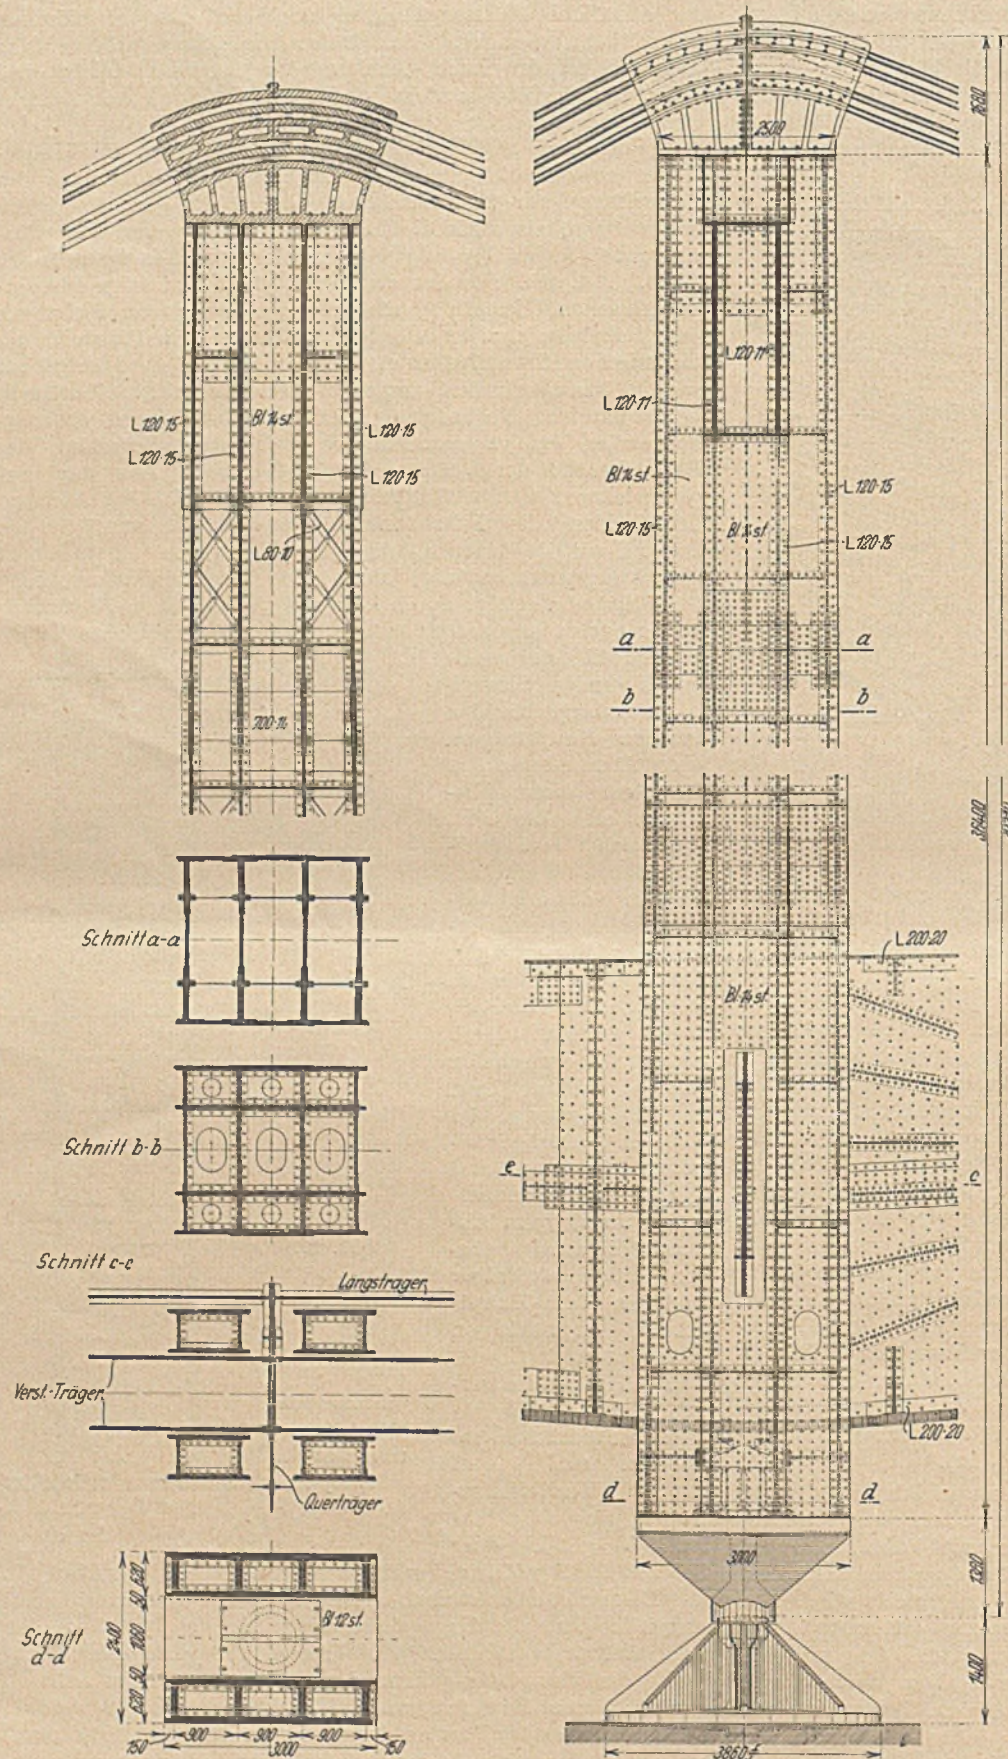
„Von Ufer zu Ufer“ „Kleine Hängebrücke“. Längsansicht und Querschnitt der Pylone.
